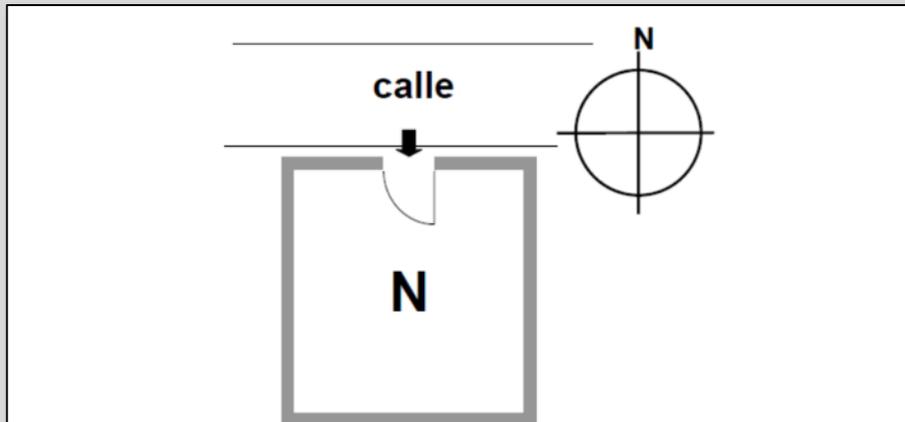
Orientación del prototipo hacia el norte (Fuente: Passivhaus Institut)
